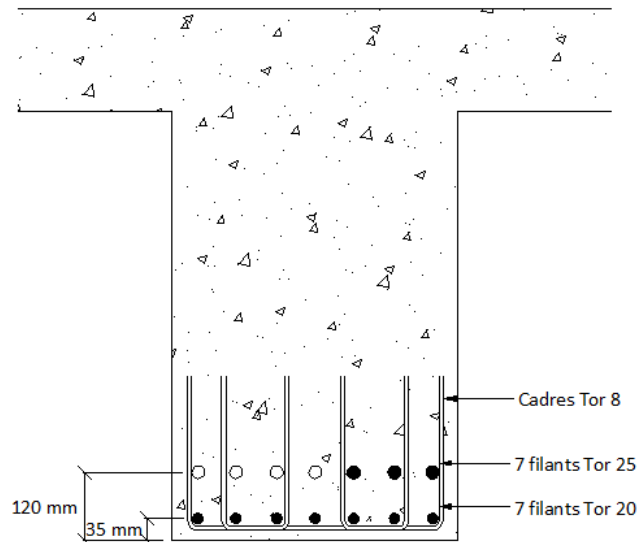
Ferrailage découvert sur la poutre Pt05 en travée 4
